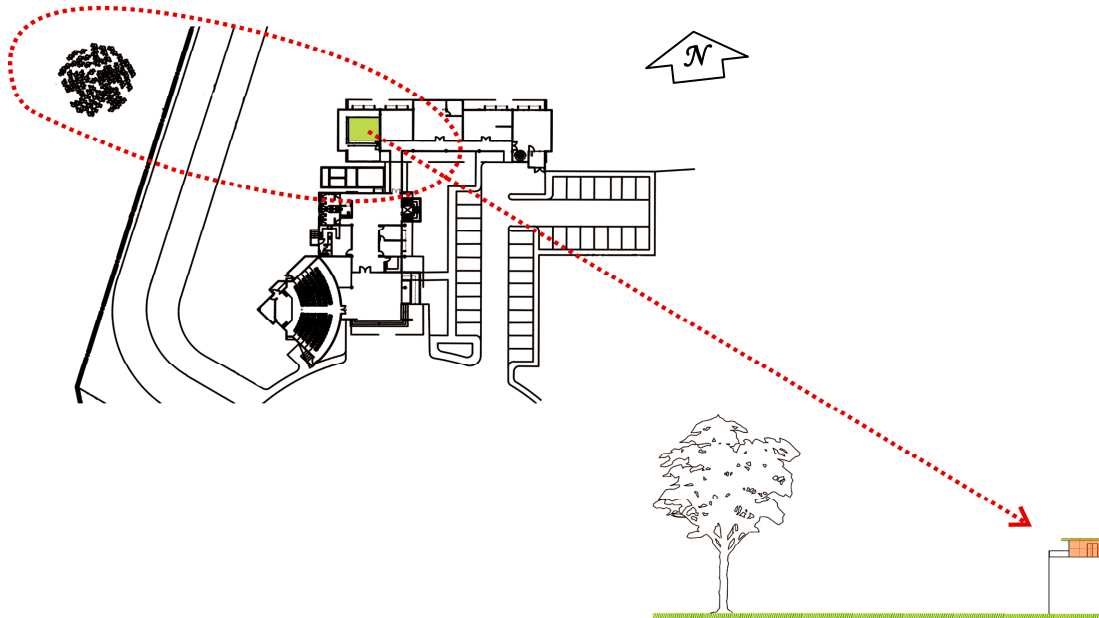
Planta de situação no pavilhão e vista lateral sul da sala experimental.
